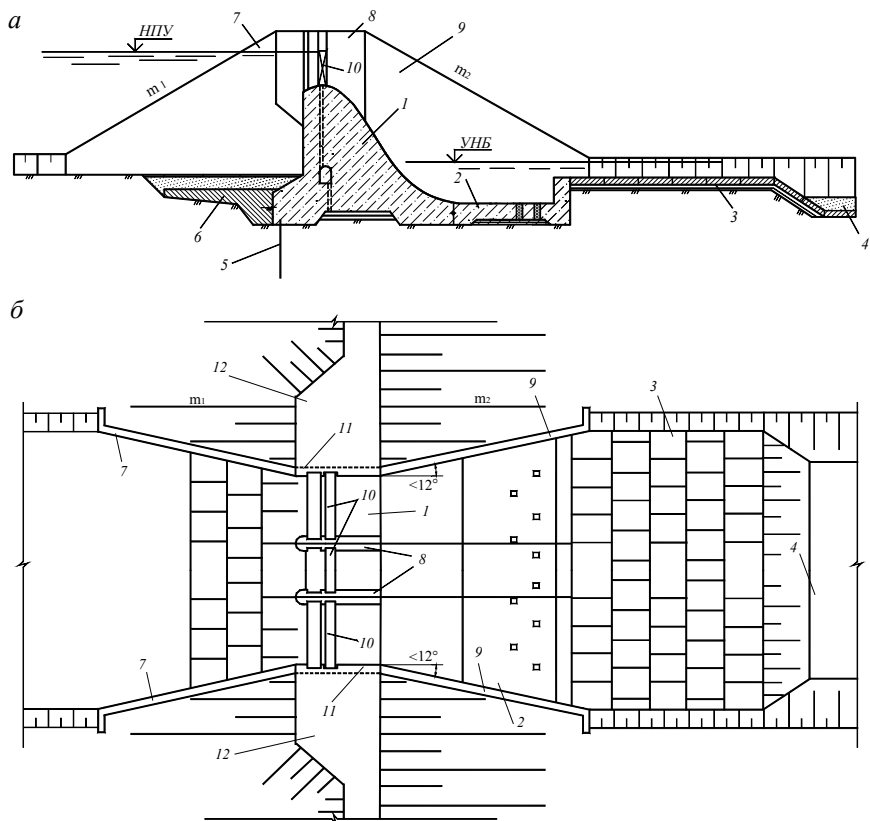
Схема бетонной водосливной плотины на нескальном основании:
